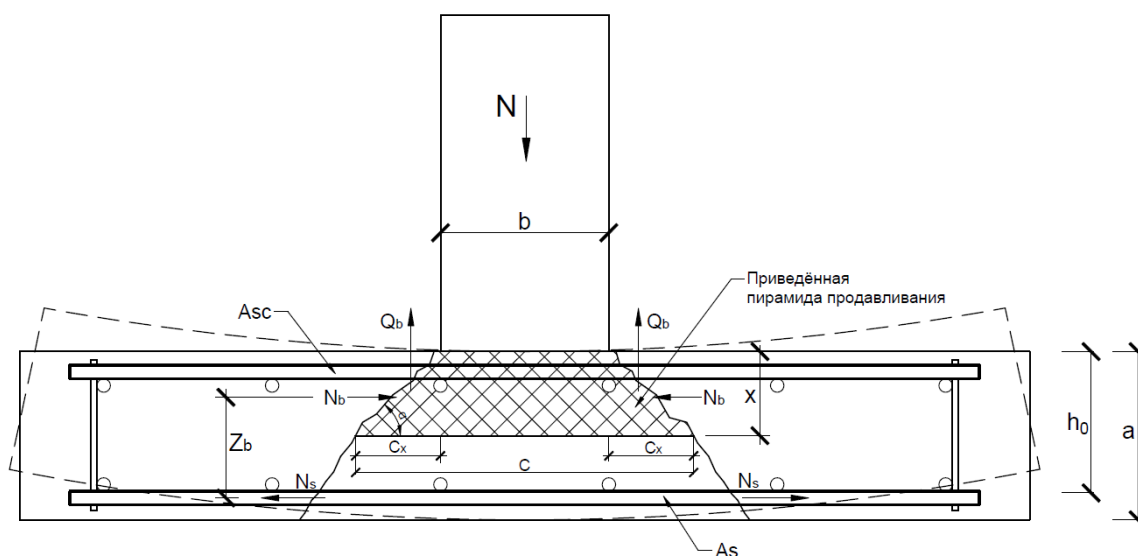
Расчетная схема к определению несущей способности узла сопряжения колонны с перекрытием при продавливании
